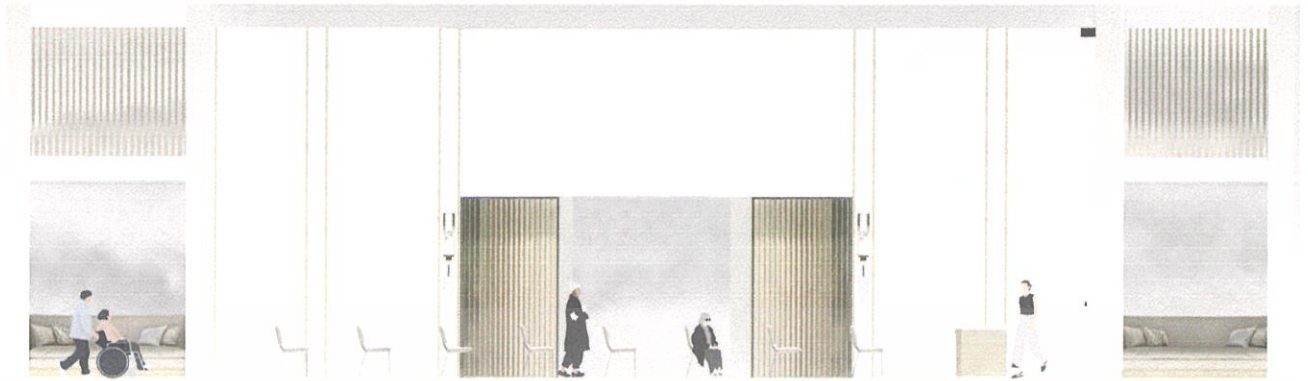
40 ELEVATION ส่วนTEA BAR
